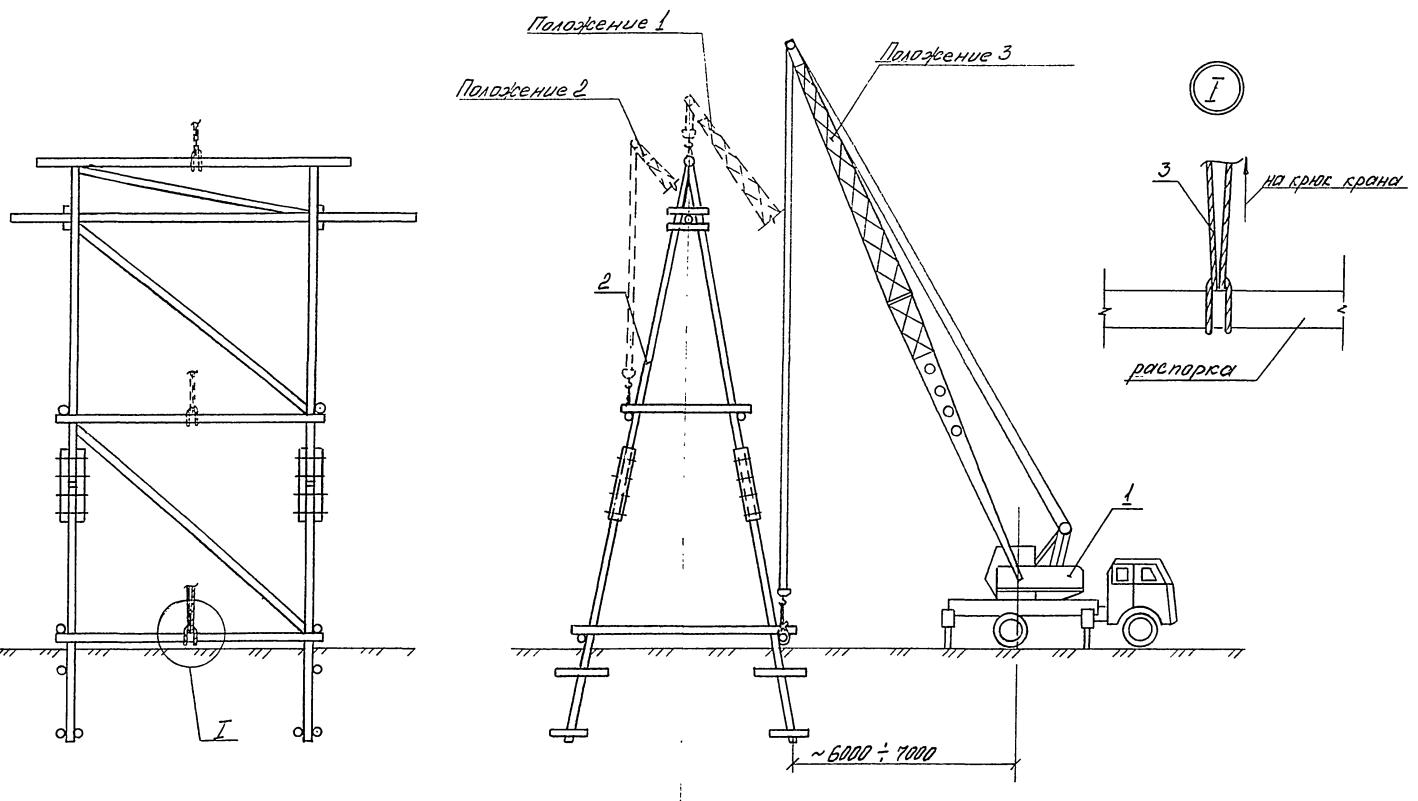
Вариант 1. Демонтаж опоры с пасынками.
